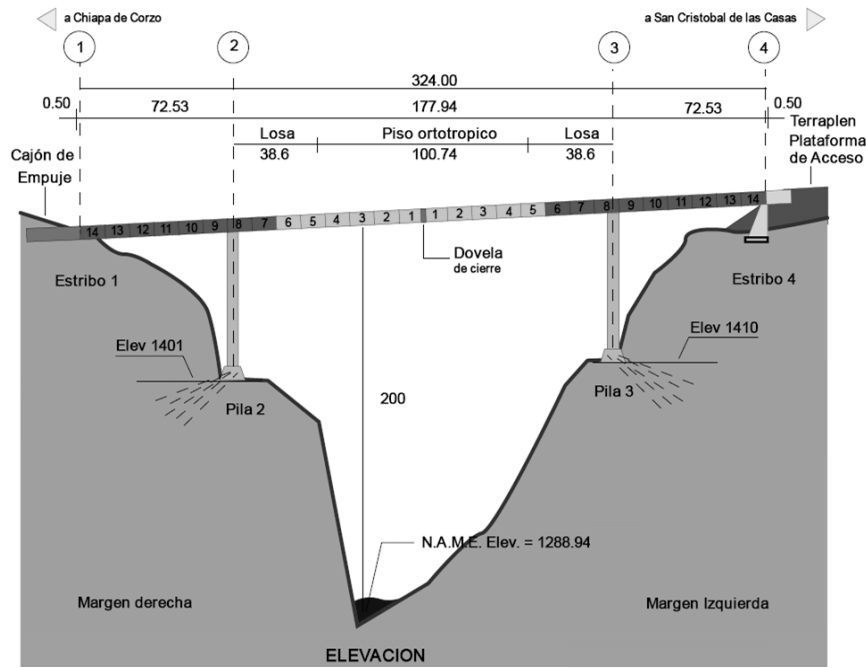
Vista en elevación del Puente San Cristóbal.
